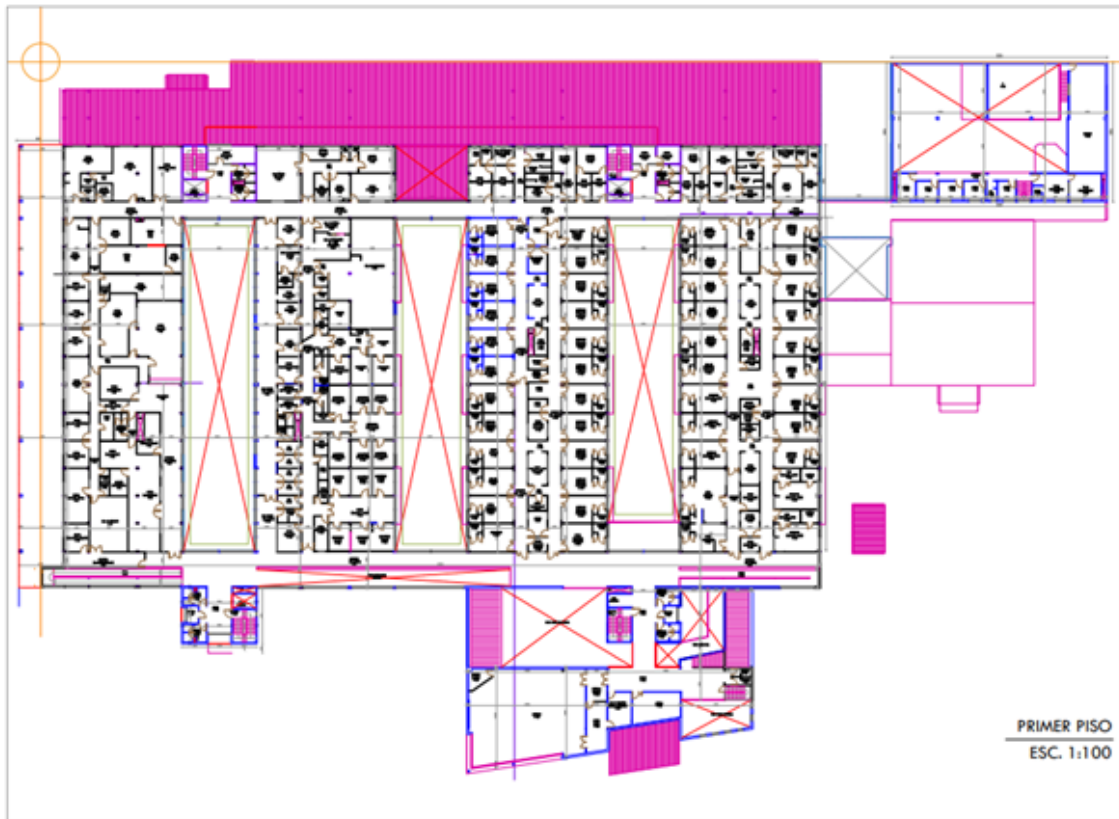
Plano de planta-Primer Piso-Ver Anexo
